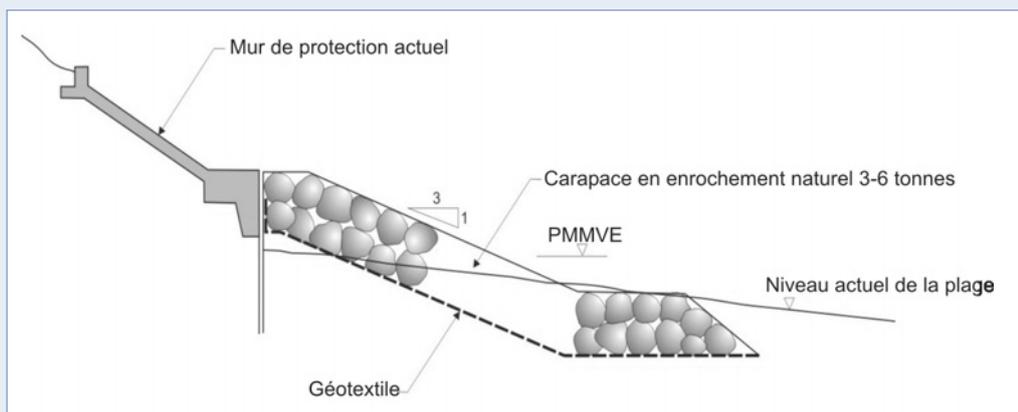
Revêtement d'un ouvrage de défense contre la mer
